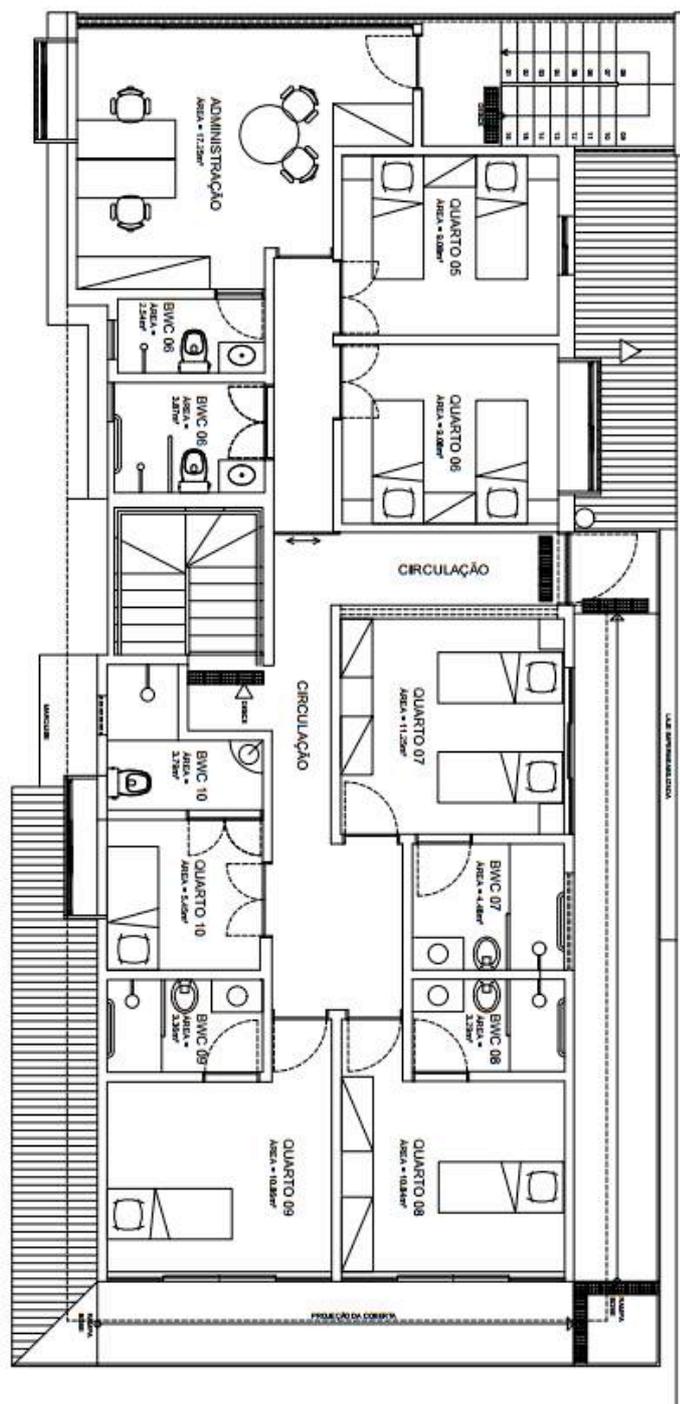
Planta Baixa do térreo do Bloco A da ILPI 6.
